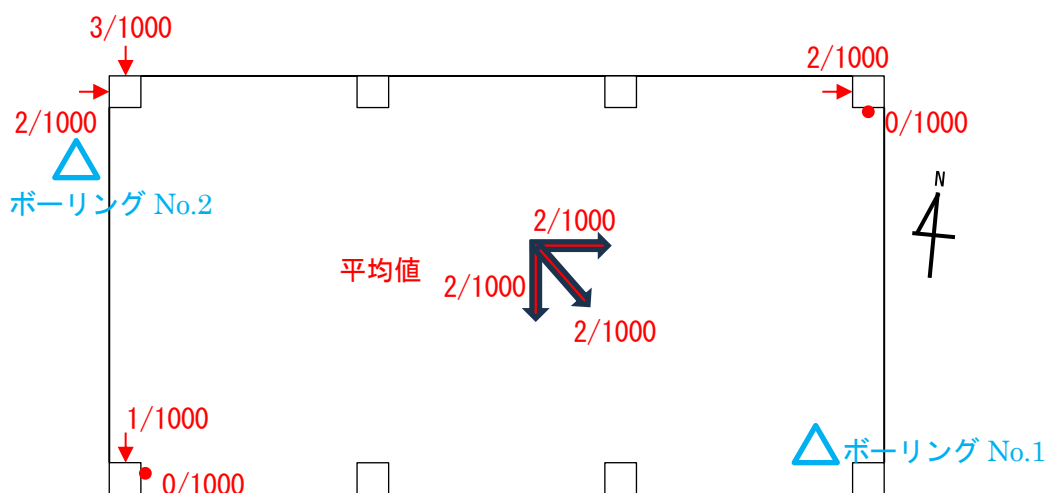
建築物 F の地上 1 階概略平面図
